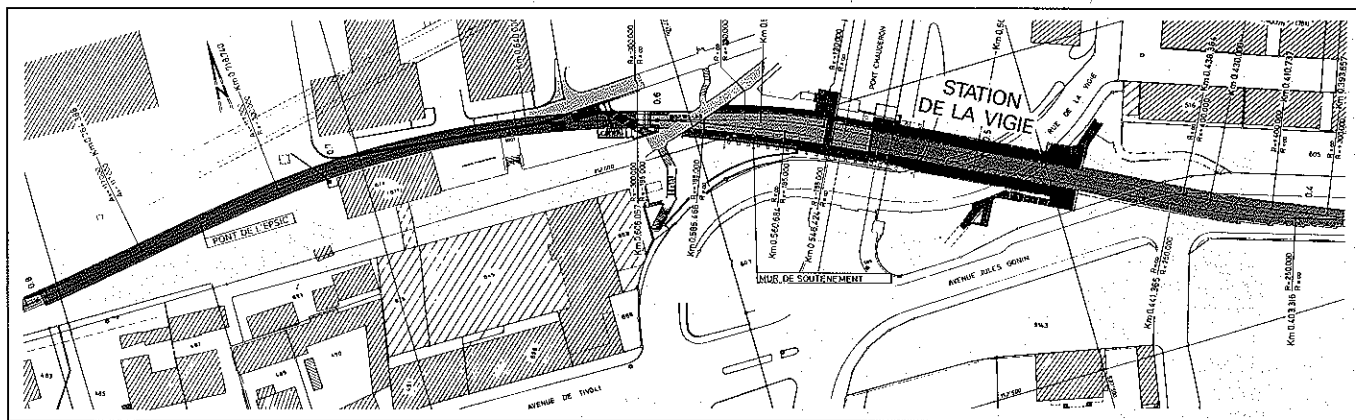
Secteur Vigie-EPSIC: plan de situation.
